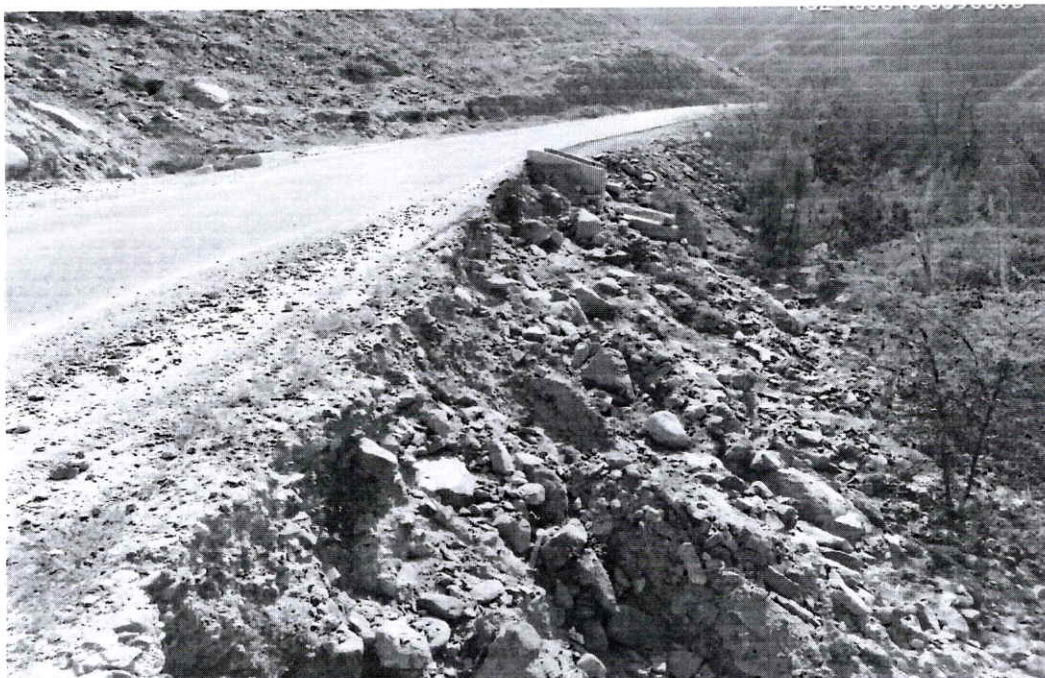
KM 11+045 DETERIORO DE MURO SECO LADO IZQUIERDO DE TALUD INFERIOR VIA, NECESITA SU REPARACIÓN.
